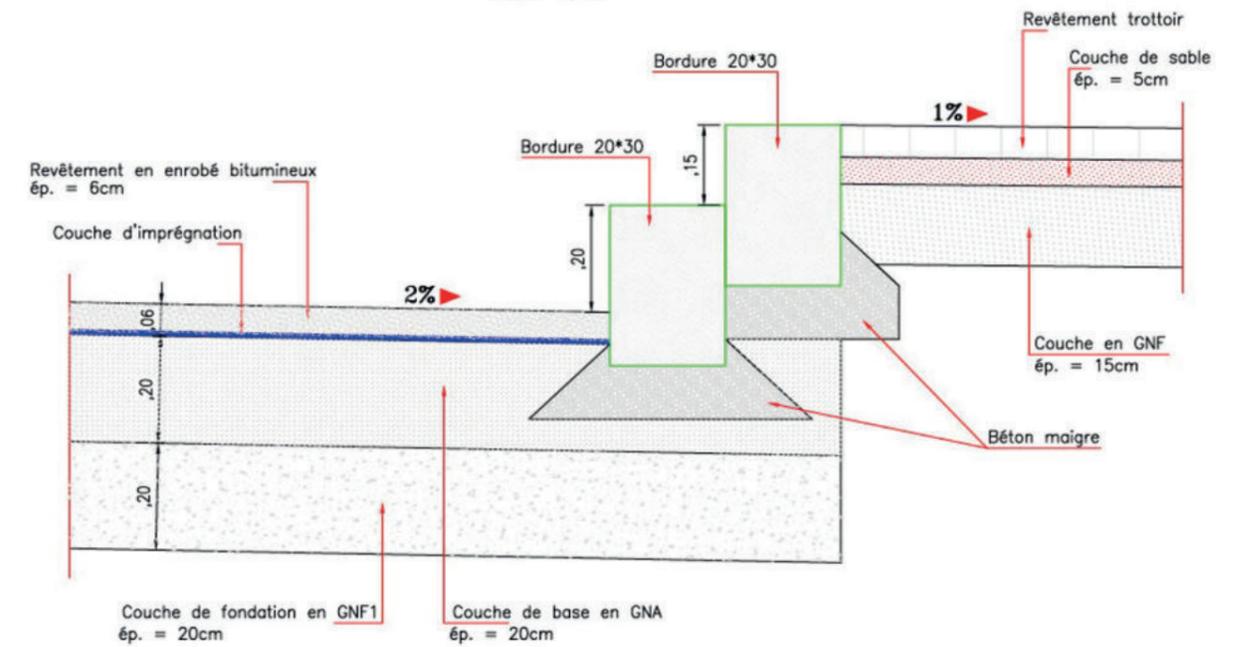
DIFFÉRENTES COUCHES D'UNE CHAUSSEE
